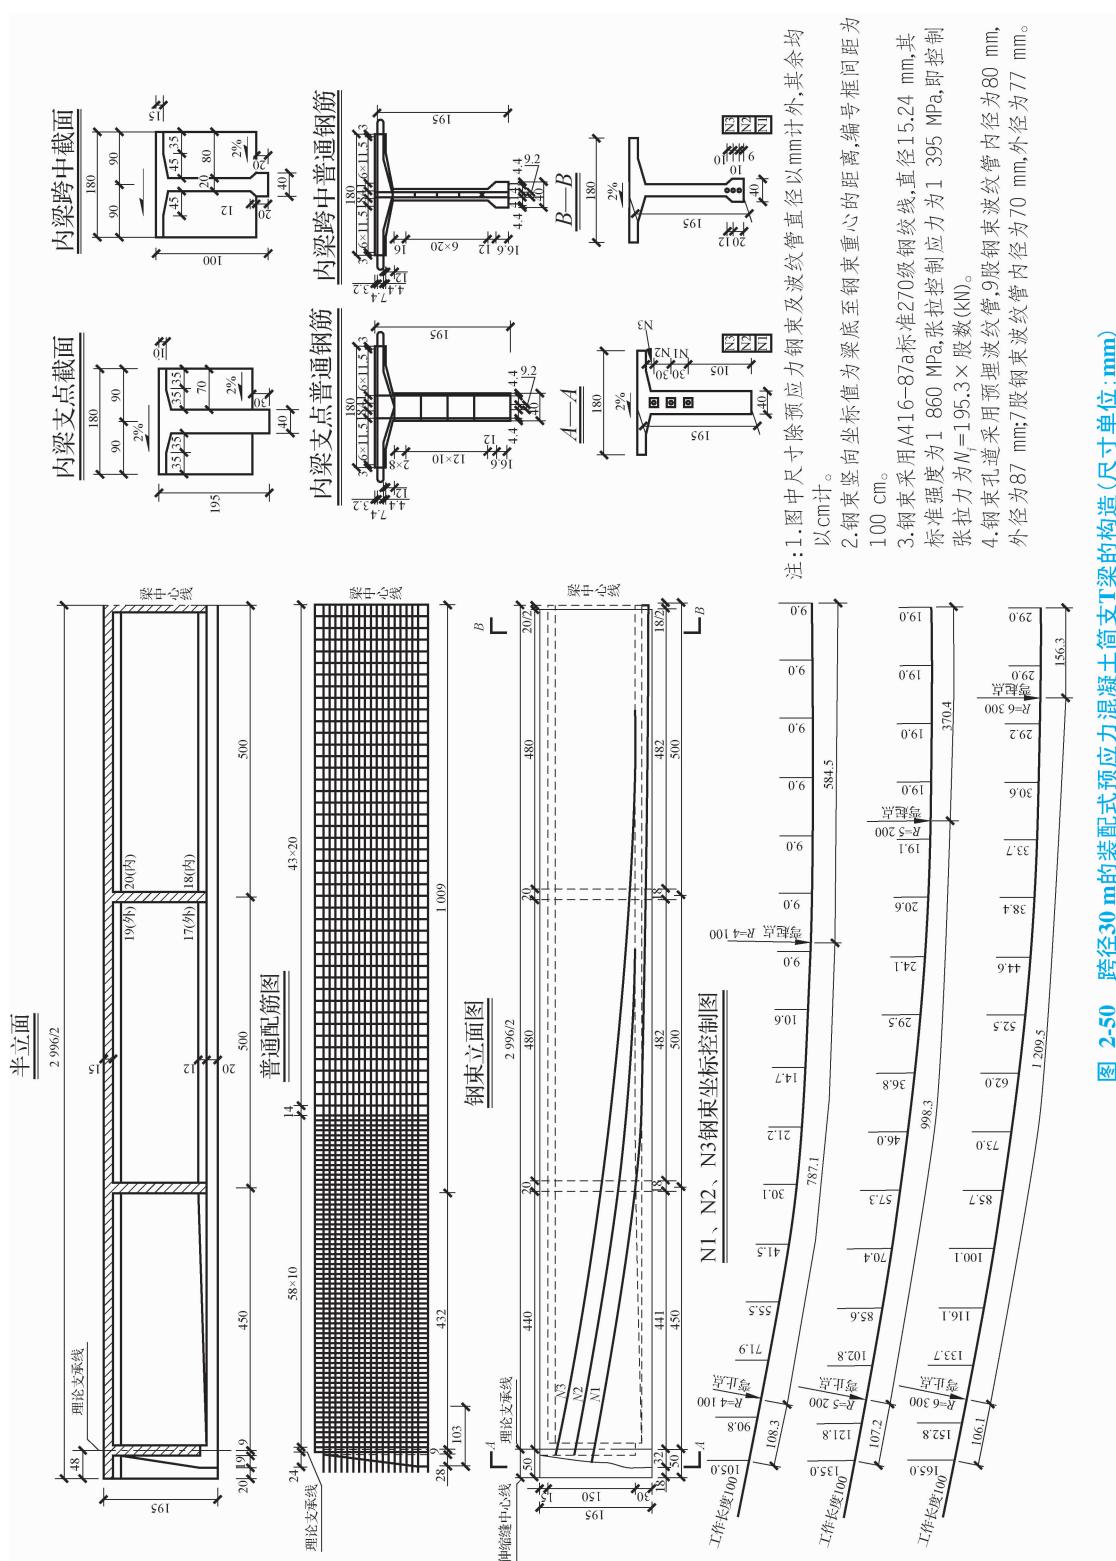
跨径30 m的装配式预应力混凝土简支T梁的构造(尺寸单位：mm)
